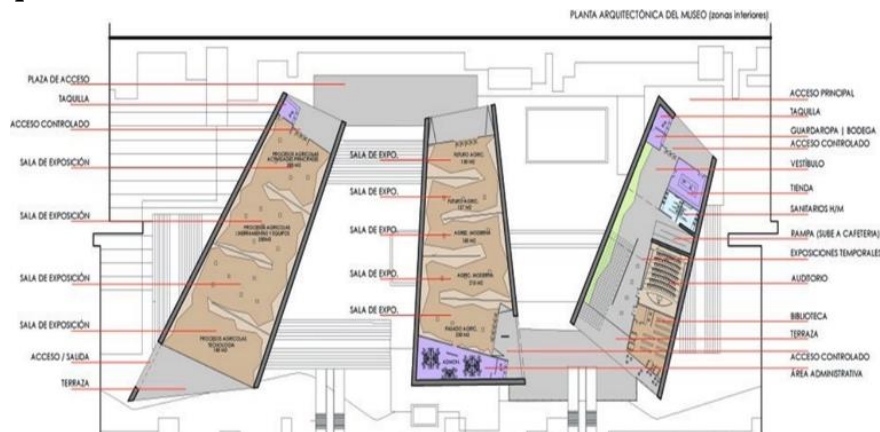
Proyecto 6 - Planta arquitectónica del museo
